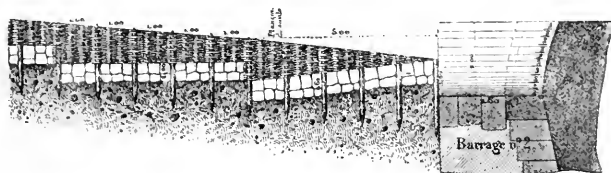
Coupe suivant C D. — Détails de la construction d'un Clayonnage longitudinal.
